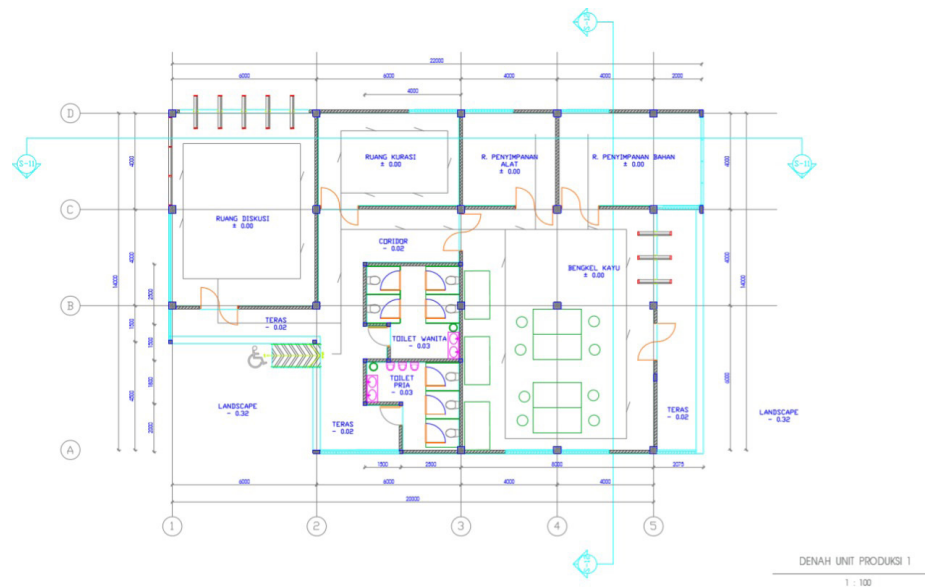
Denah Bangunan Utama Penulis (2020)
